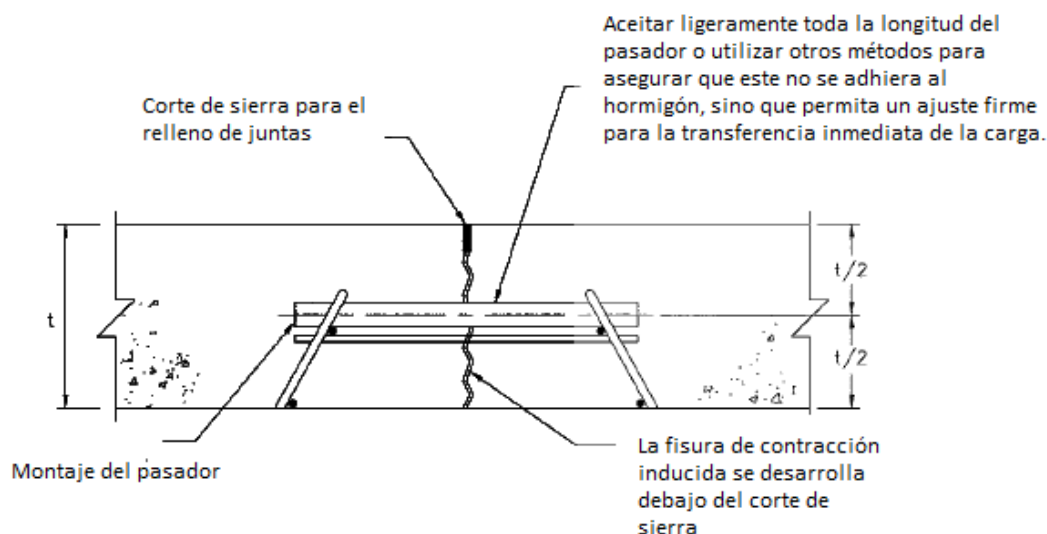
Junta de construcción con pasador (ACI 360, 2016)
